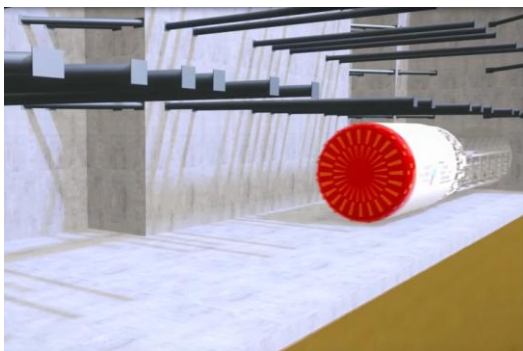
Passage du tunnelier dans le puits-gare, source [2]
